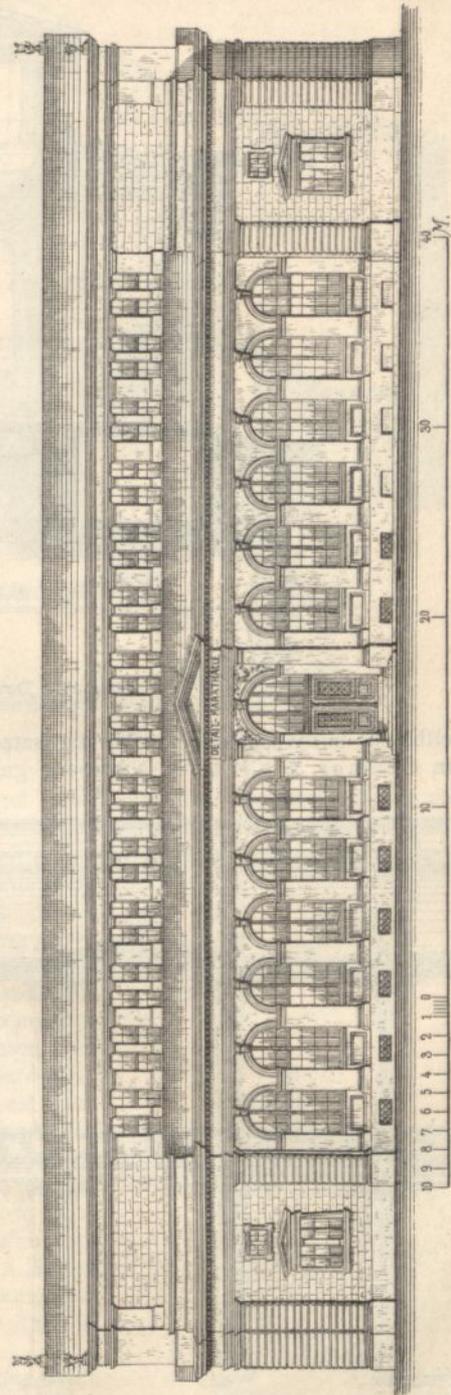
Detail-Markthalle am Paradeplatz in Wien.
